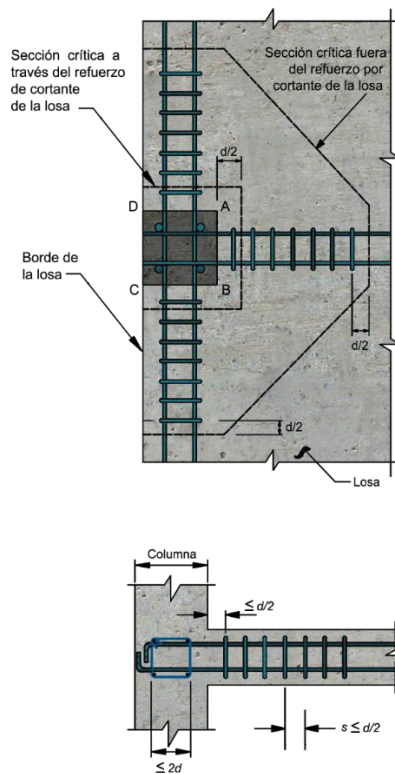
f – Arreglo del refuerzo por cortante en forma de estribos en losas que trabajan en dos direcciones para el caso de columnas de borde (adaptada de ACI CODE-318-19)
